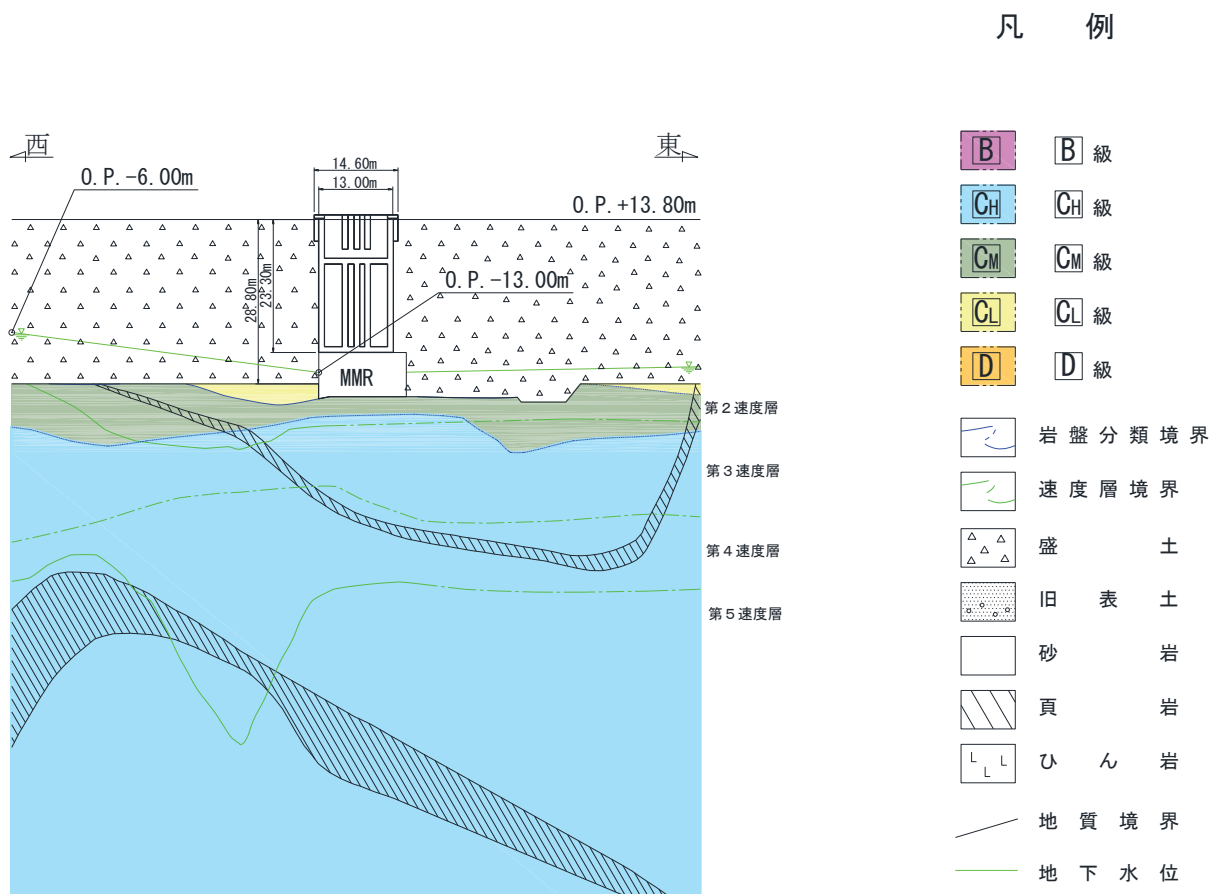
第 3 号機補機冷却海水系放水ピットの解析断面図 (EW 断面) (3/3)
